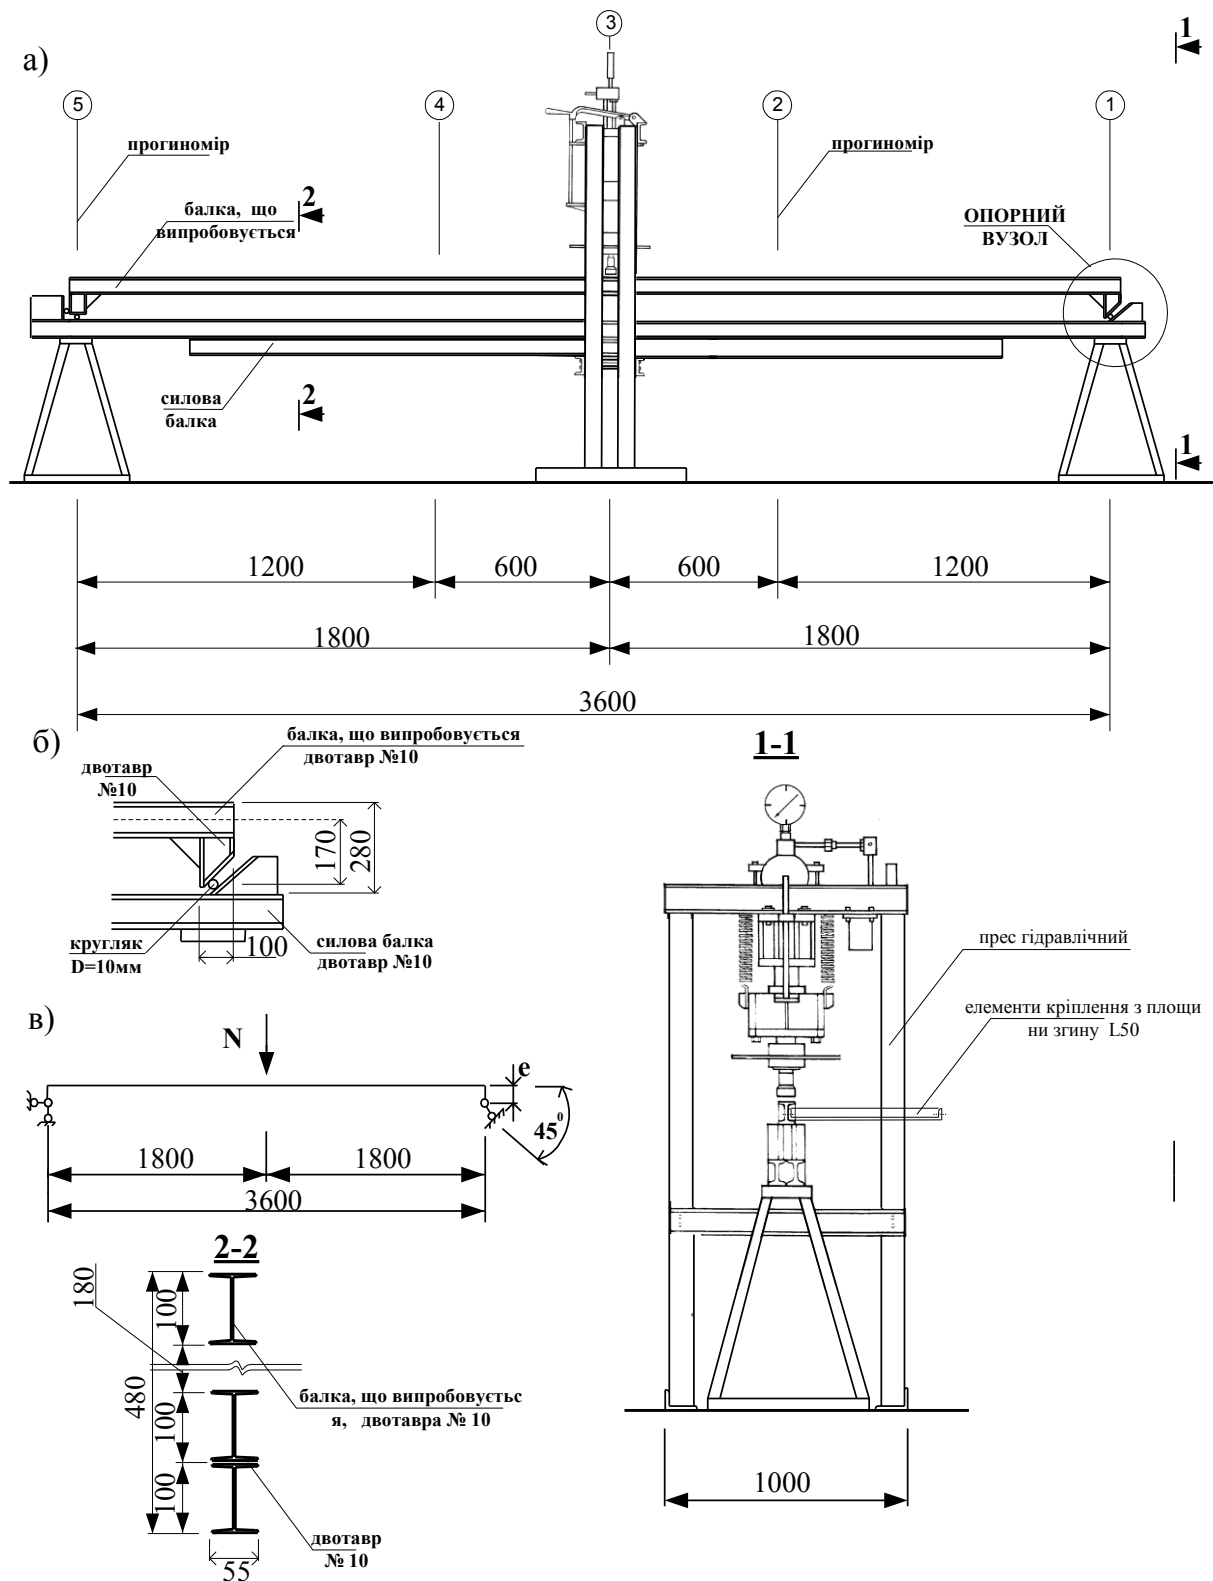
Схема стенда з випробування балок на похилих опорах:
